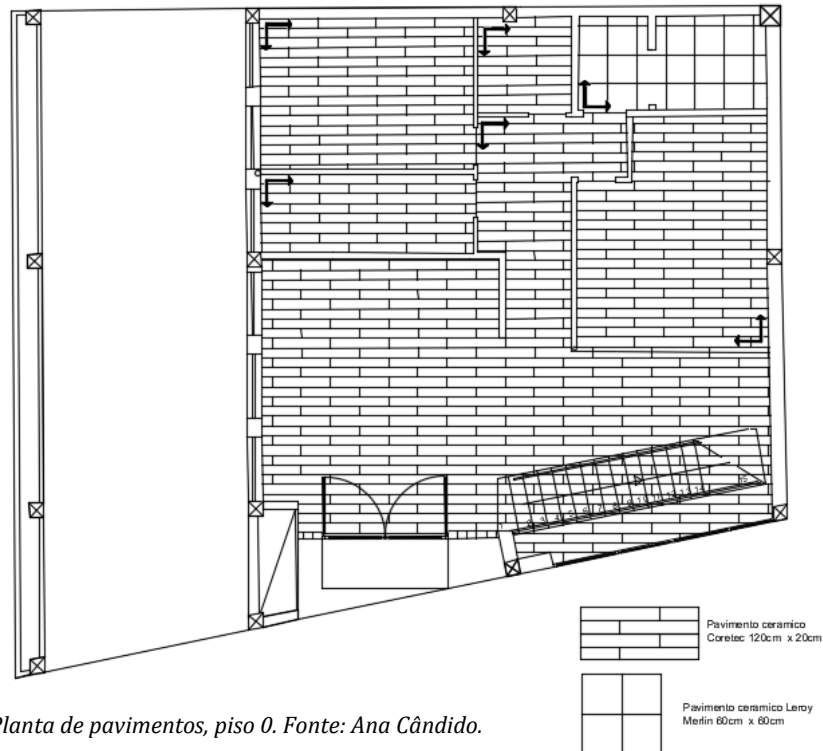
Planta de pavimentos, piso 0. Fonte: Ana Cândido.
